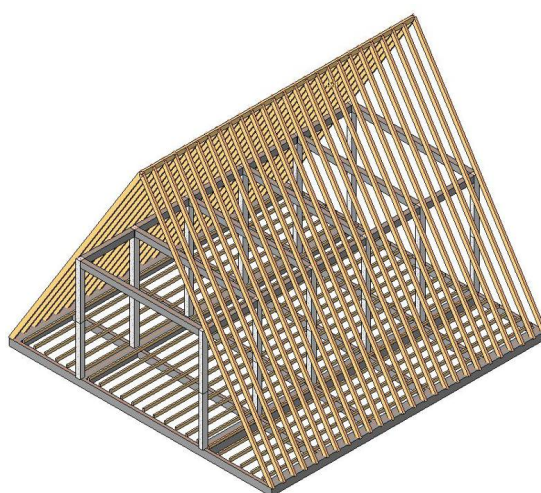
Więźba dachowa z krokiewmi ciągłymi z drewna klejonego o geometrii szkieletu żelbetowego z dodatkowym stropem i zastrzałem rygła pośredniego w połowie wysokości.
